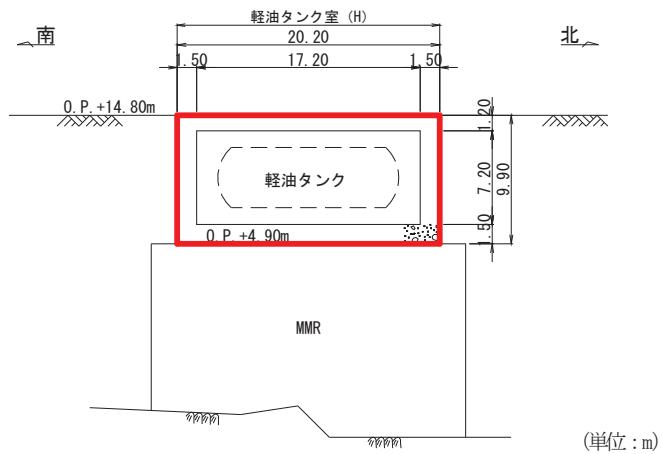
軽油タンク室 (H) 断面図 (A-A)
